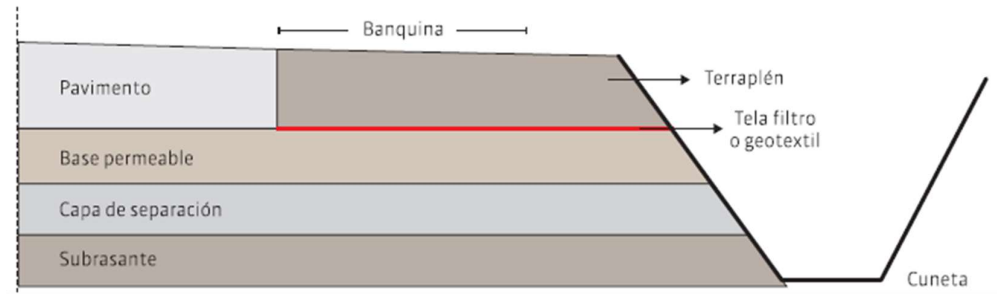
| Diseño del subdrenaje de pavimentos de diseño. Fuente: (Calo et al., 2014, C2)
